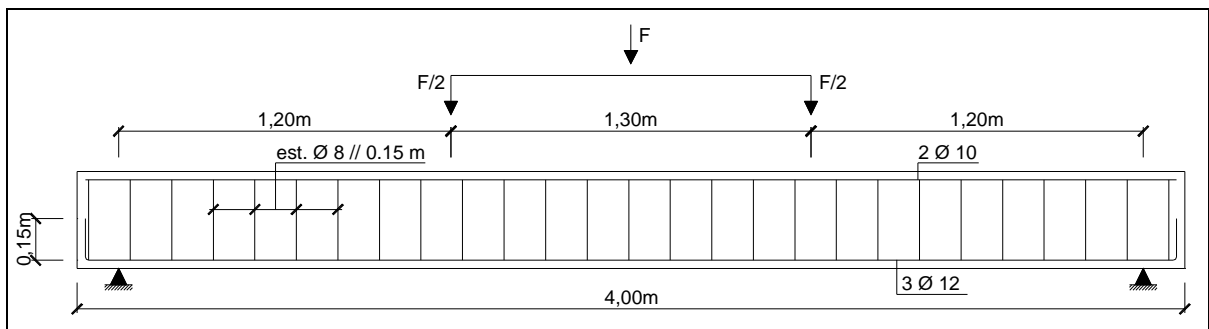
Secção longitudinal das vigas de aço inoxidável da 1.ª série.
